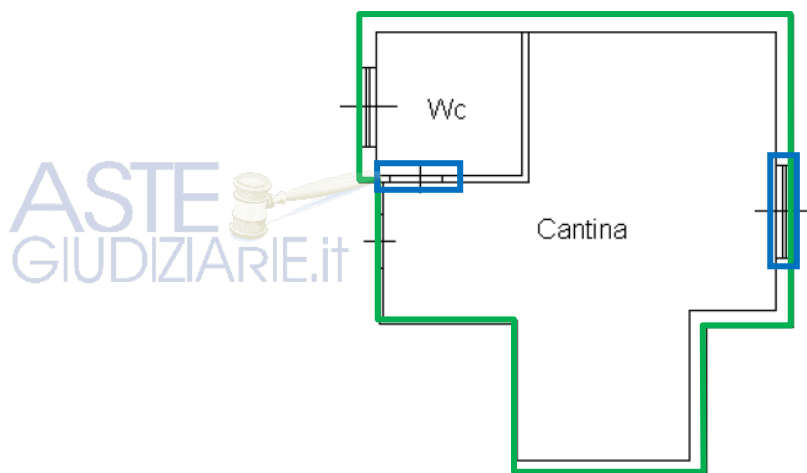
Planimetria catastale con indicazione della sagoma della cantina.
